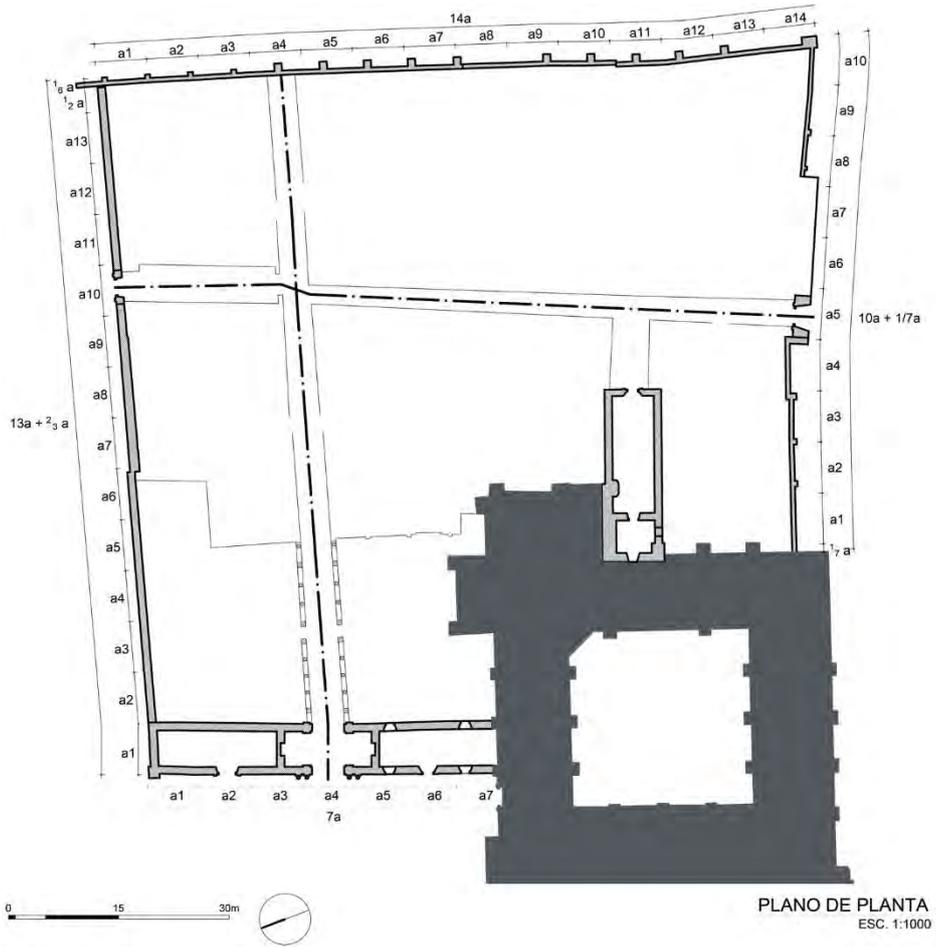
Plano de modulación de la planta del CRLAC. Elaboración propia.
